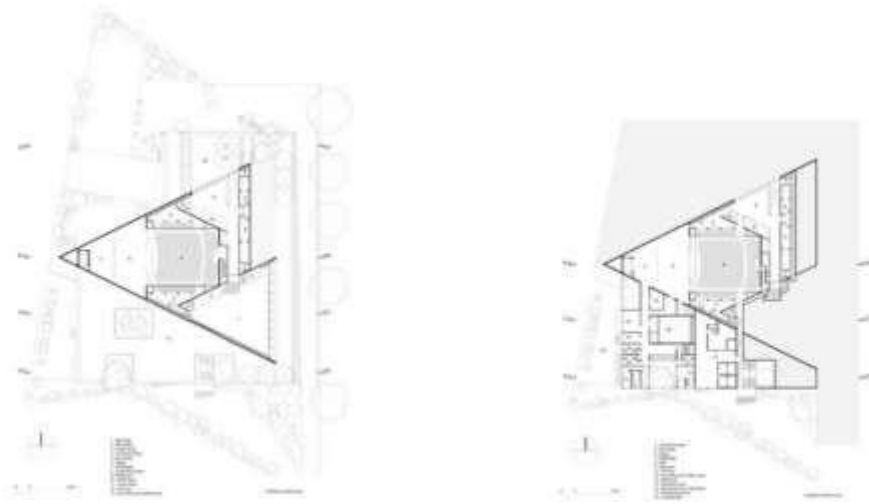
Planos arquitectónicos Centro Cultural Teopanzolco.
